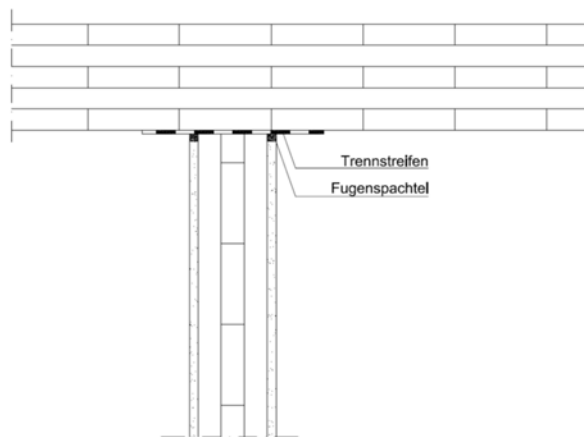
Anschlussdetail einer bekleideten Brettsper Holzwand an eine Deckenkonstruktion in Anlehnung an [ÖNORM B 2320]
